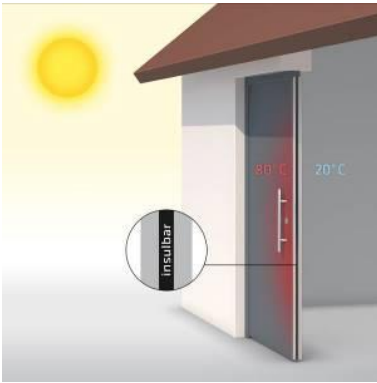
Conjunto ensamblado de aluminio con perfil aislante insulbar sin cizallamiento: la zona aislante móvil compensa eficazmente las diferentes dilataciones longitudinales del perfil interior y exterior del sistema de metal condicionadas por la temperatura.
